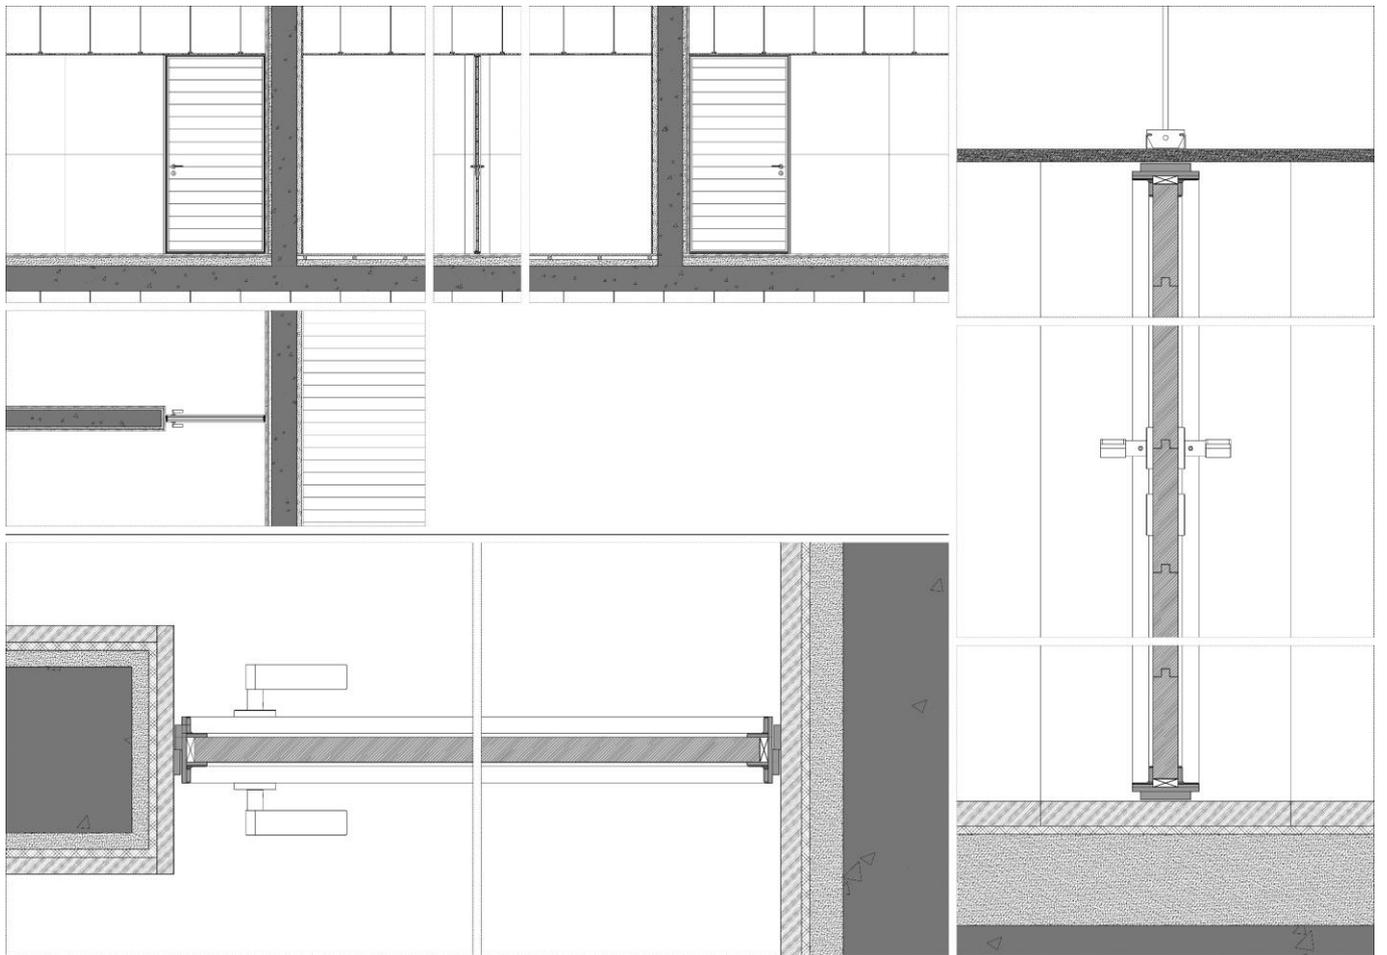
Ilustração LV | Pormenor construtivo vão tipo 5 | Escala gráfica
